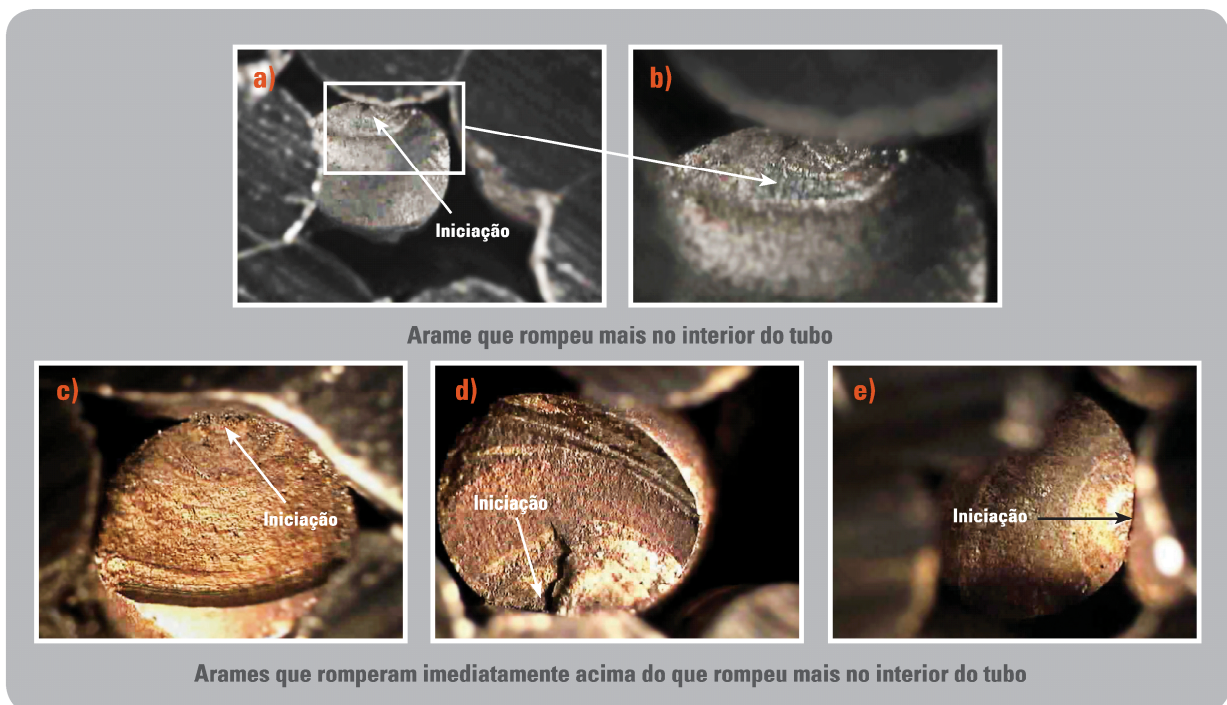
Superfícies de fractura do lado do cabo encastrado no tubo. Localização relativa das zonas de iniciação da fissuração nas superfícies de fractura: a) rotura com propagação total por fadiga e com iniciação em picada na zona de contacto com um arame vizinho; b) pormenor da fotografia a); c) rotura quase total com propagação por fadiga com iniciação em picada na zona de contacto com a parede interior do tubo de encastramento; d) rotura total com propagação por fadiga com iniciação em duas picadas na zona de contacto com um arame vizinho; e) rotura total com propagação por fadiga com iniciação em duas picadas na zona de contacto com um arame vizinho.
